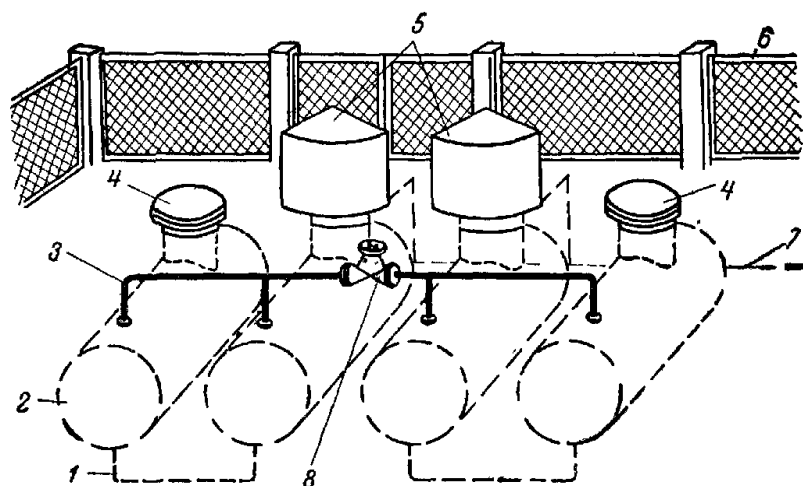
Групповая резервуарная установка: 1 - трубопровод жидкой фазы; 2 - резервуар; 3 - трубопровод паровой фазы; 4 - заглушка; 5 - защитный кожух арматурной головки; 6 - ограда; 7 - газопровод к потребителю; 8 — вентиль
